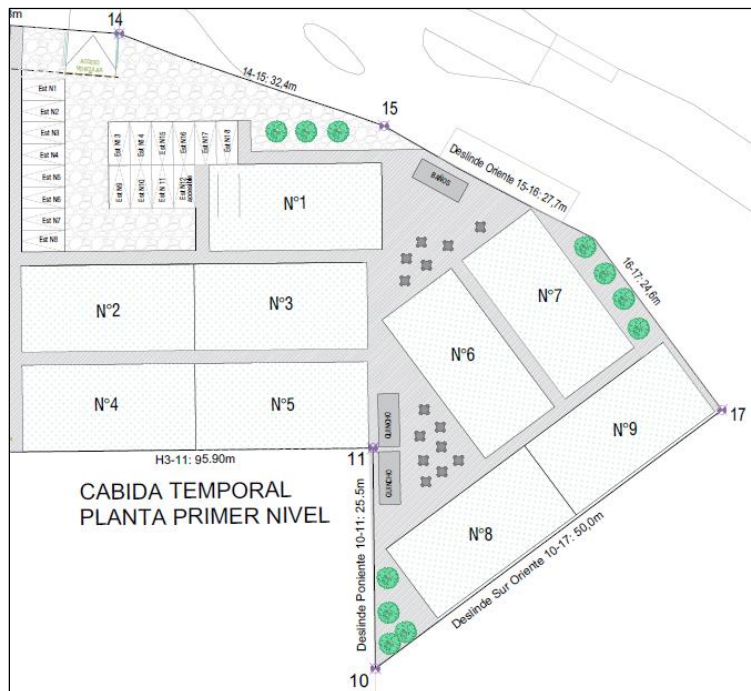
Planta Recinto deportivo Canchas de Padel
